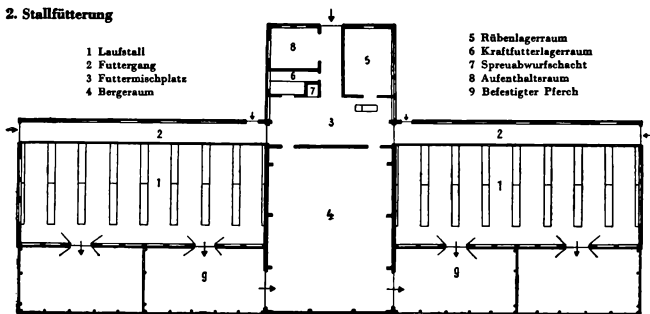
Grundriß eines Schafstalles mit Futterbergeraum
